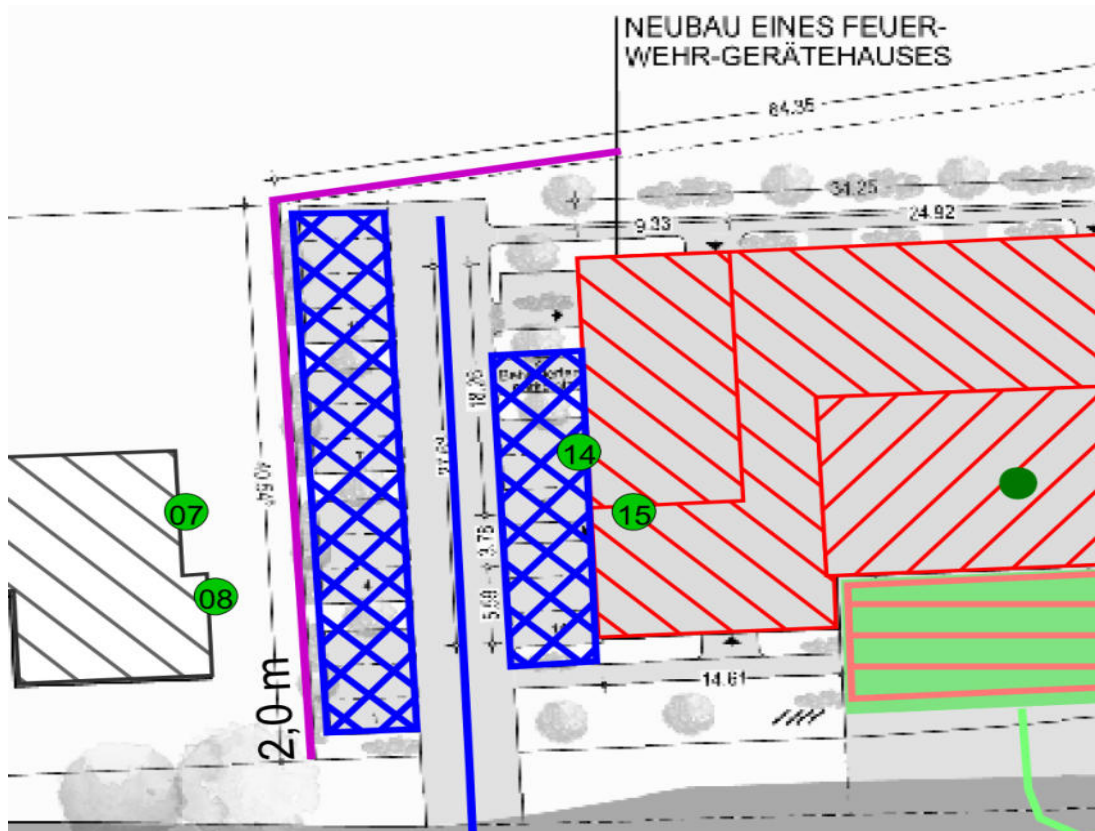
Detaillageplan einer möglicher Lärmschutzwand
